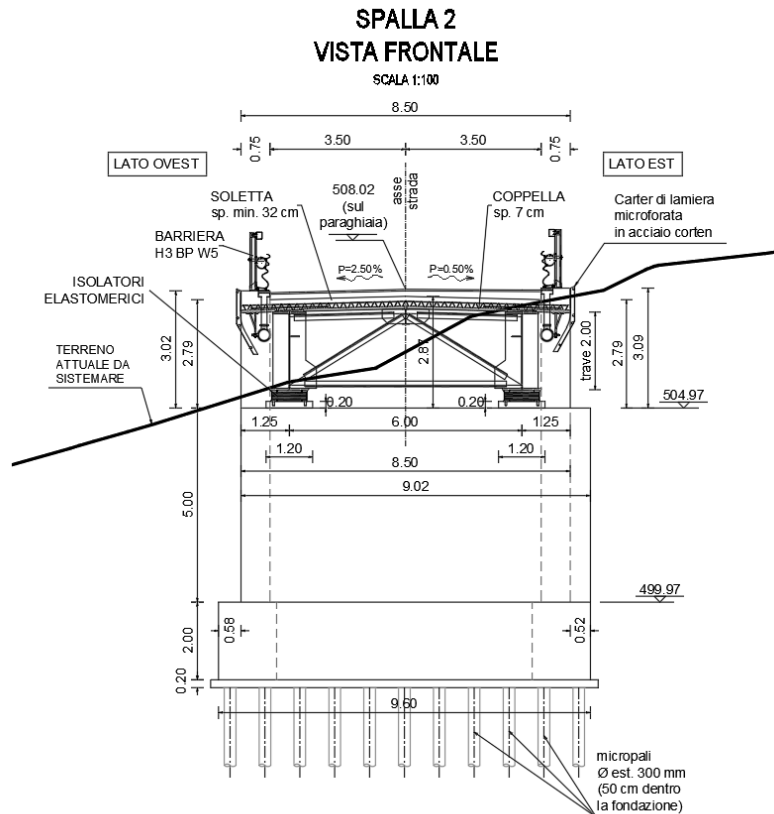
Prospetto longitudinale e sezioni trasversali
